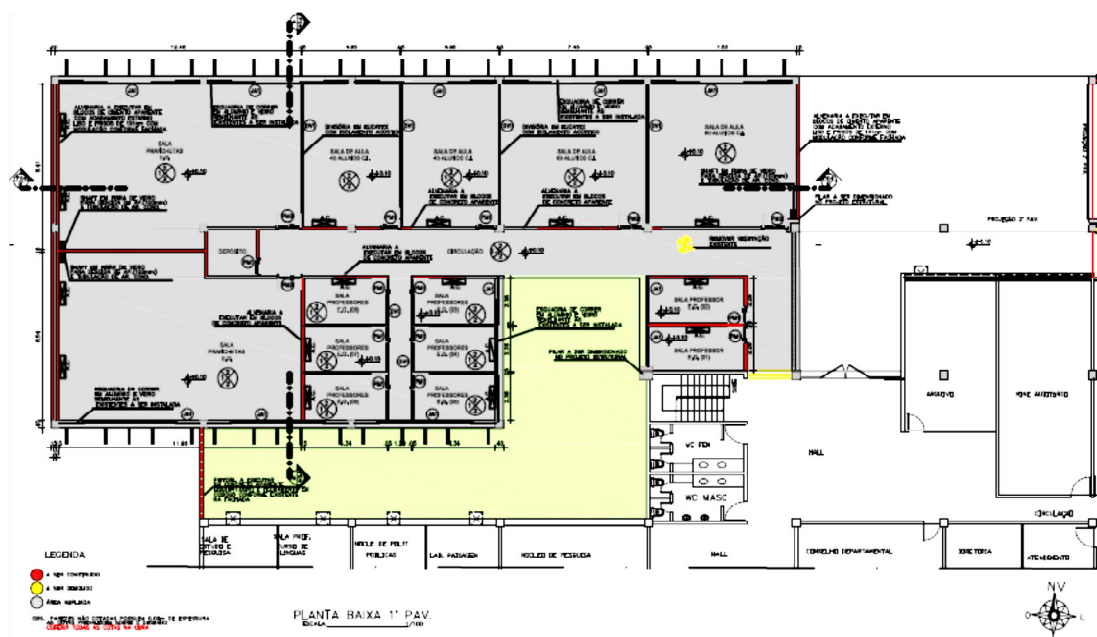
Planta Baixa do primeiro pavimento do projeto de expansão do CAC.
